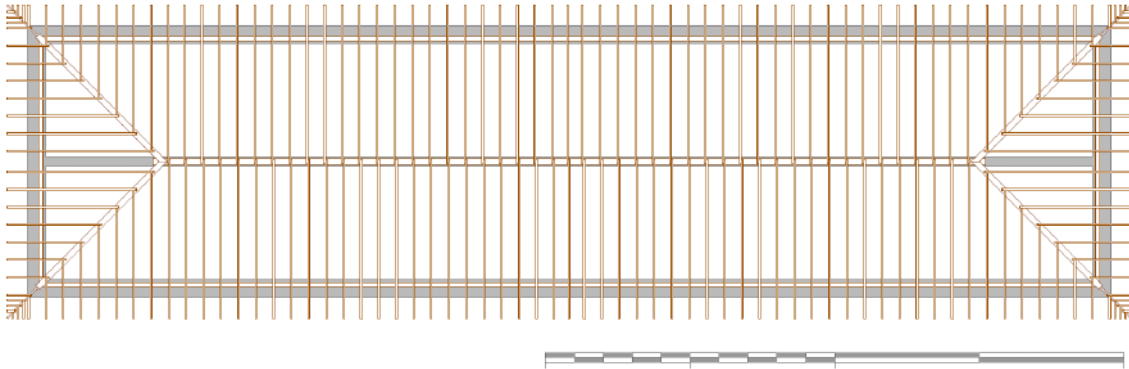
Sistema de pendiente de la cubierta. 2016. Fuente Propia
